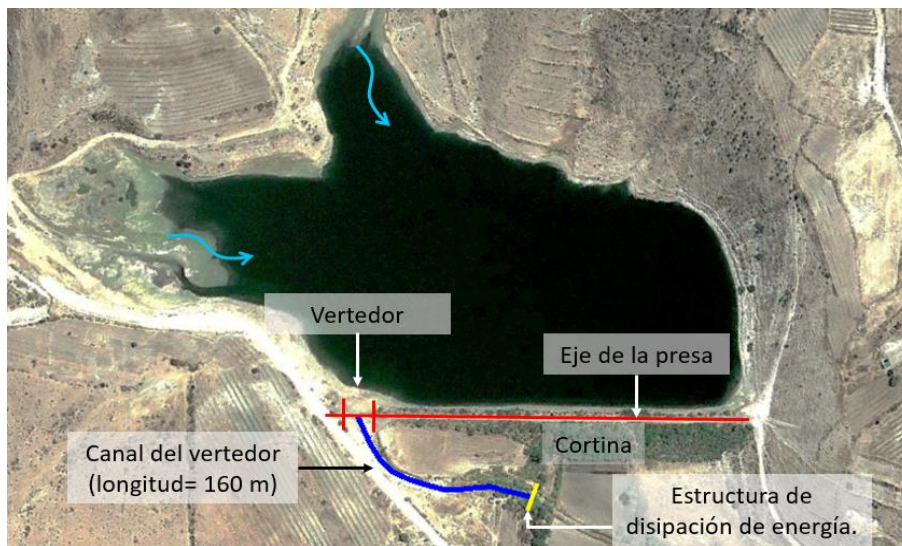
Vista en planta de la presa (Google Earth, versión 2018).
